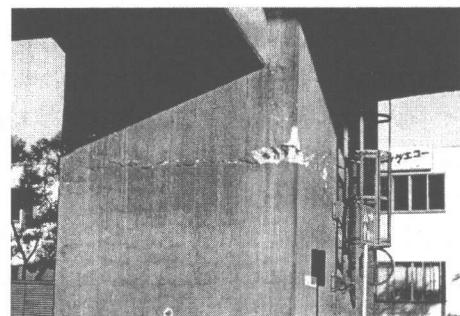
RC 橋脚の水平輪切り状ひび割れ
